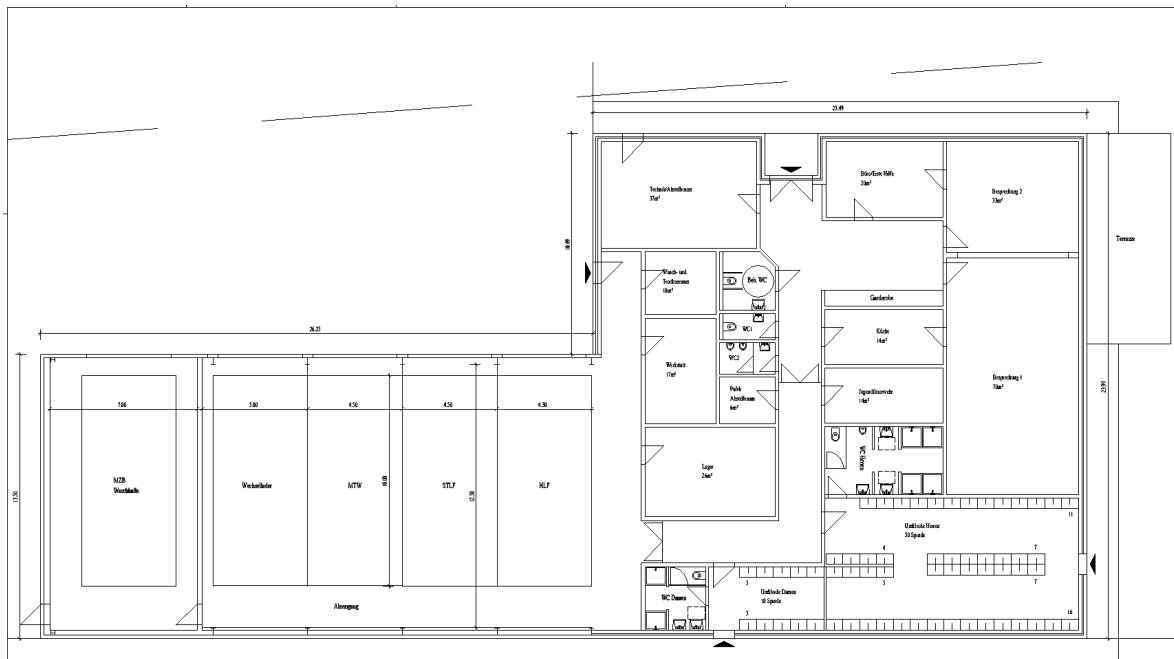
Grundriss Feuerwehrrätehaus Variante D [20]
